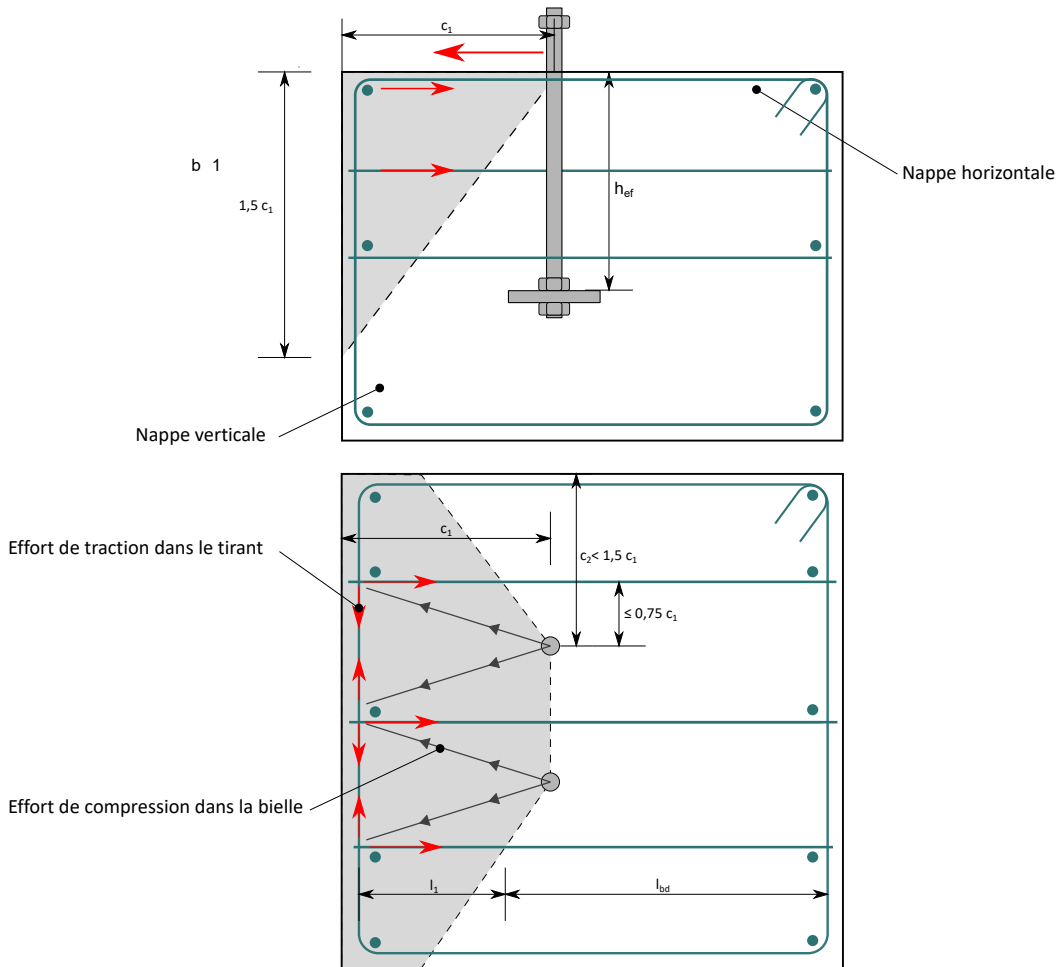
Exemple de ferrailage pour empêcher la rupture du bord du béton
